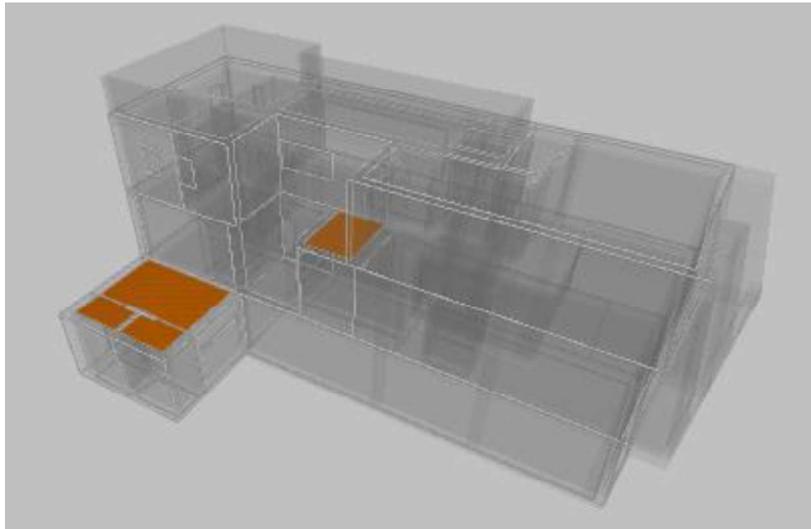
Situación de Cubiertas Extensión Planta Baja y Patio Interior en la vivienda. CYPETHERM HE Plus
